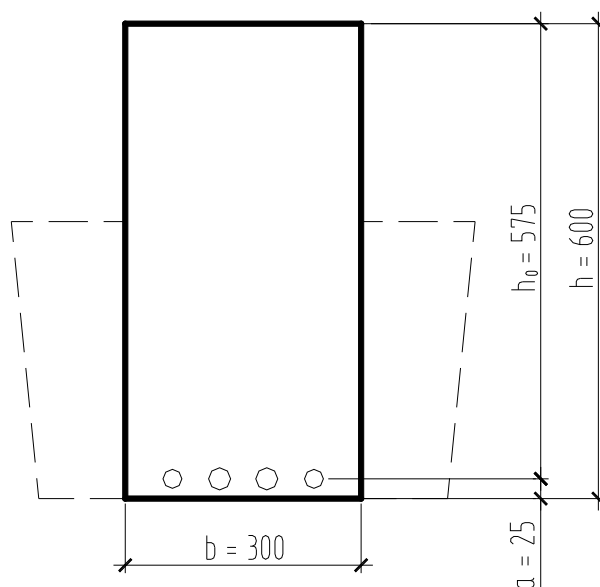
Розрахунковий переріз ригеля
